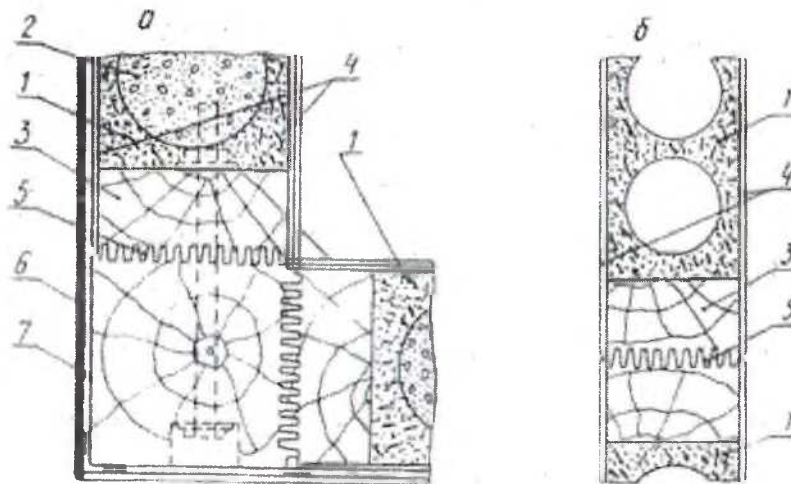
Конструкции и системы узлового соединения наружных стен (а), стеновых перегородочных блоков: 1 – многопустотная древесностружечная плита; 2 – наполнитель каналов (перлит, пенопласт и др.); 3 – каркас панели; 4 – облицовочный материал (ДВП); 5 – зубчатая система соединений; 6 – экран (асбестоцементные или цементно-стружечные плиты, кирпич, тонкие железобетонные плиты и др.); 7 – воздушный зазор
